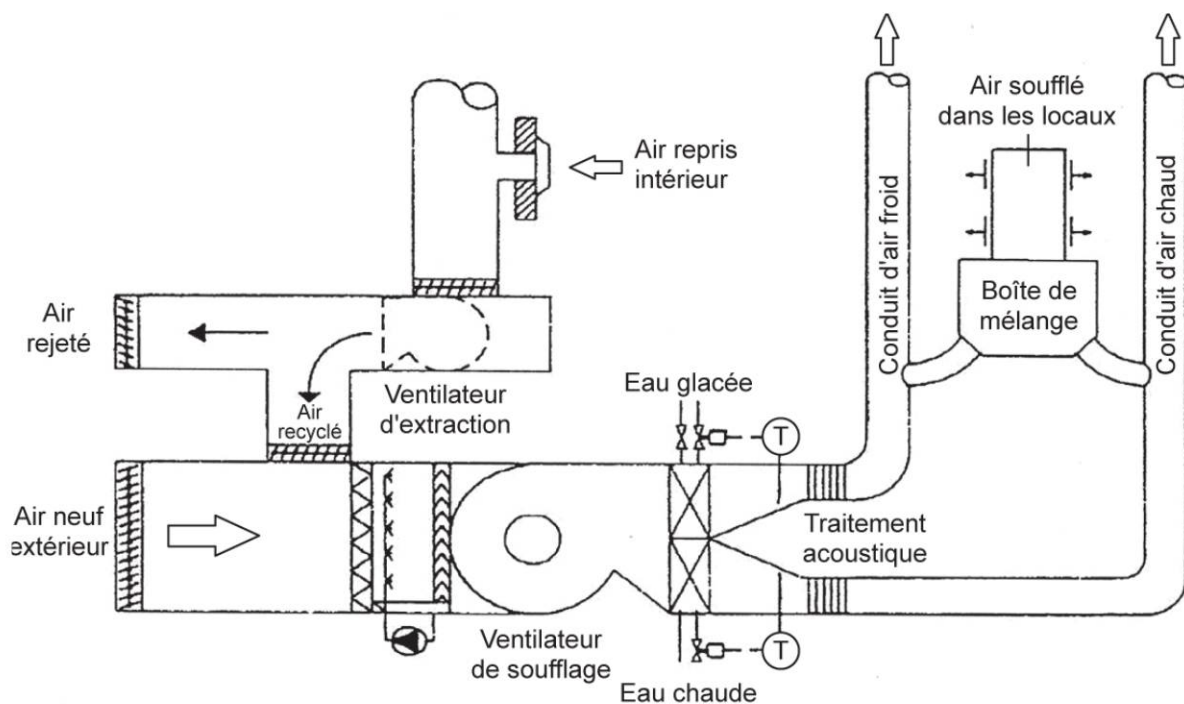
Schéma de principe d'une installation à 2 conduits
